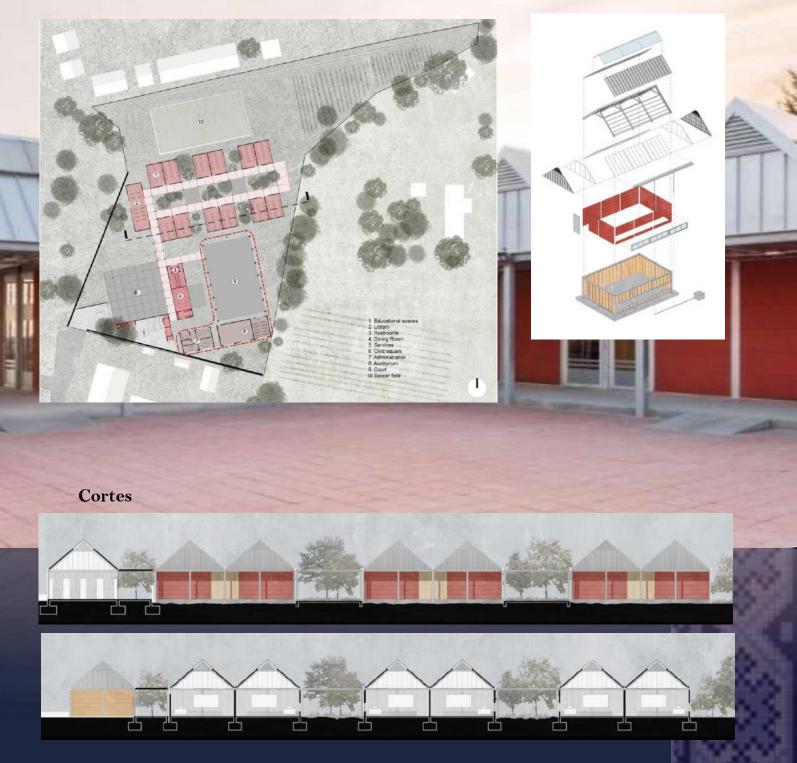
Planta conjunto, cortes elaborado por ESCOBEDO SOLIZ, GUTIÉRREZ ARQUITECTOS.
